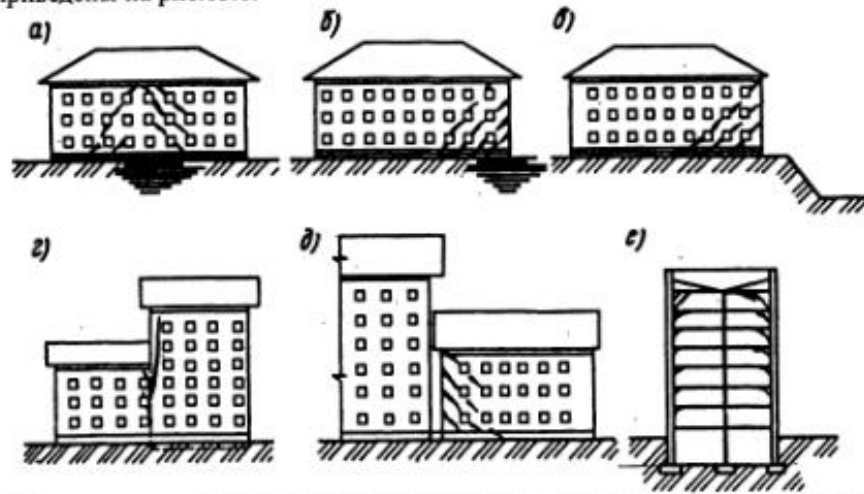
Причины трещинообразования в несущих стенах: а – наличие слабых грунтов под средней частью здания, б – то же, у торца; в – обширная выемка грунта возле здания; г – отсутствие осадочного шва; д – близкое размещение нового многоэтажного здания вблизи малоэтажного; е – разница осадок пересекающихся стен
